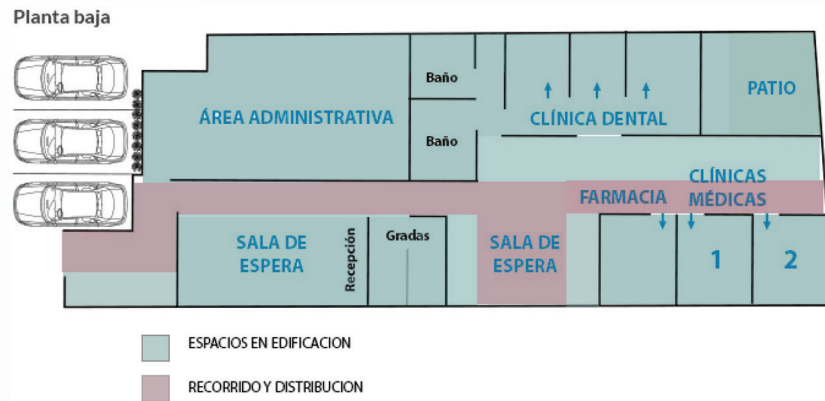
Diagrama de recorridos en áreas de la edificación #1 - Planta Baja.
